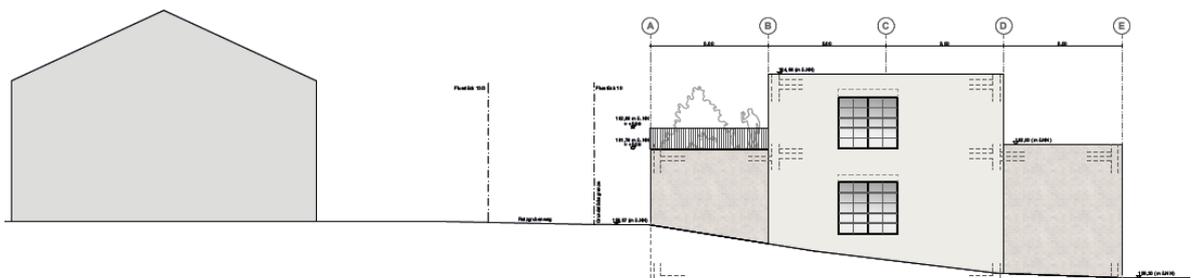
Ansicht Ostseite mit Nachbarbebauung Retzgrubenweg 15 (Schaack + Schank Architekten, Stand: 04.01.2023)
